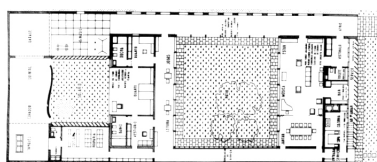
Planta baixa do Pavilhão Médiçi, projetado por Daniele Calabi (1946).
